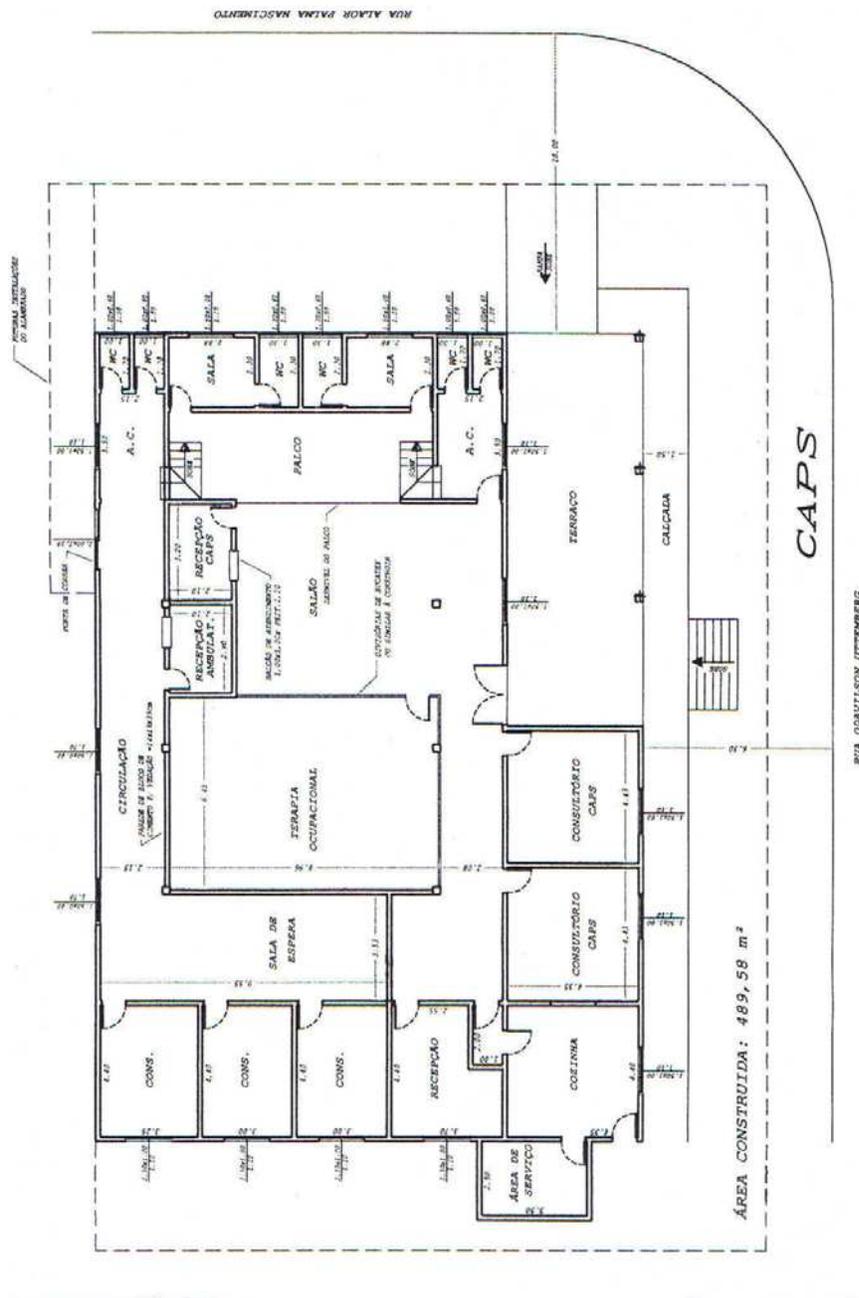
Figura IV – Planta Baixa do CAPS Pedreira, 2002
